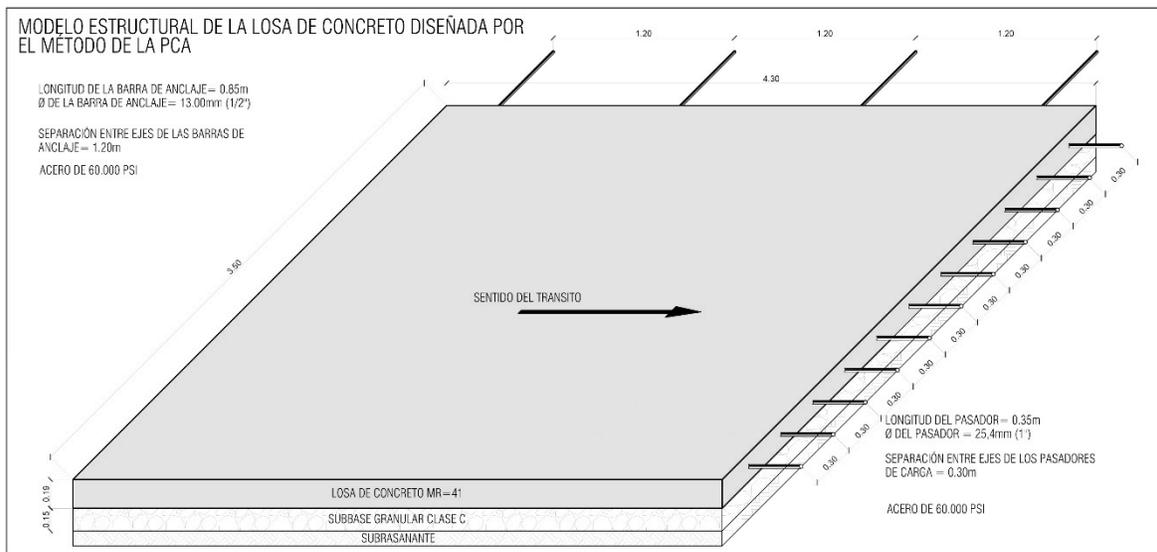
Esquema de la losa de pavimento de concreto (18 cm)
